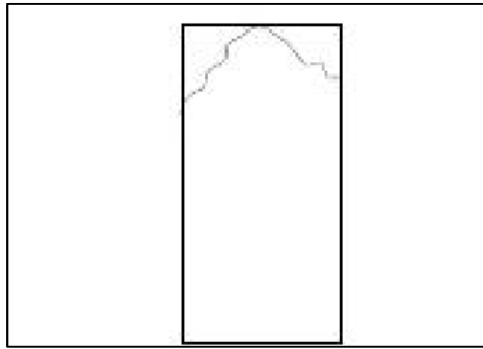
fractura tipo IV. Fuente. NTP 339.034 / ASTM C-39
